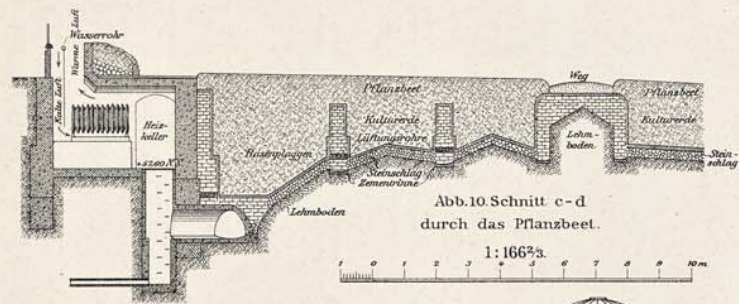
Schnitt c-d durch das Pflanzbeet. 1:166⅔.
